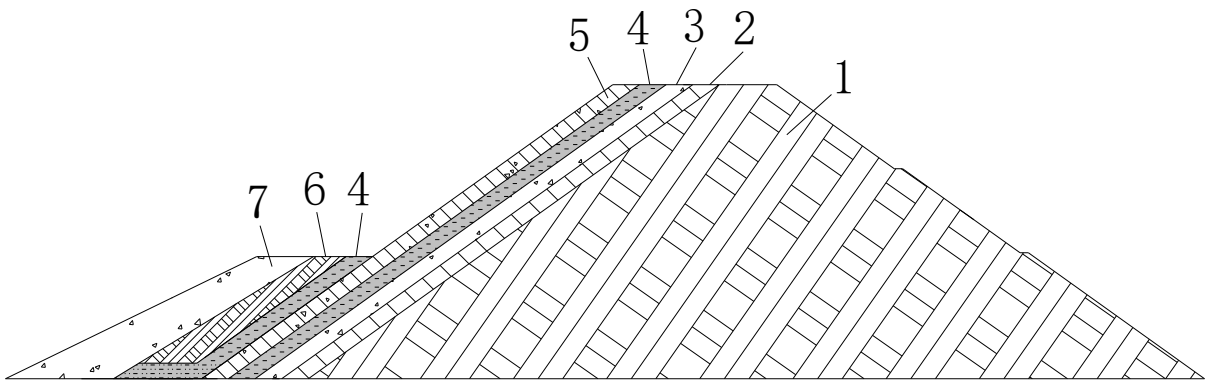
混凝土面板土石坝防渗设计示意图
